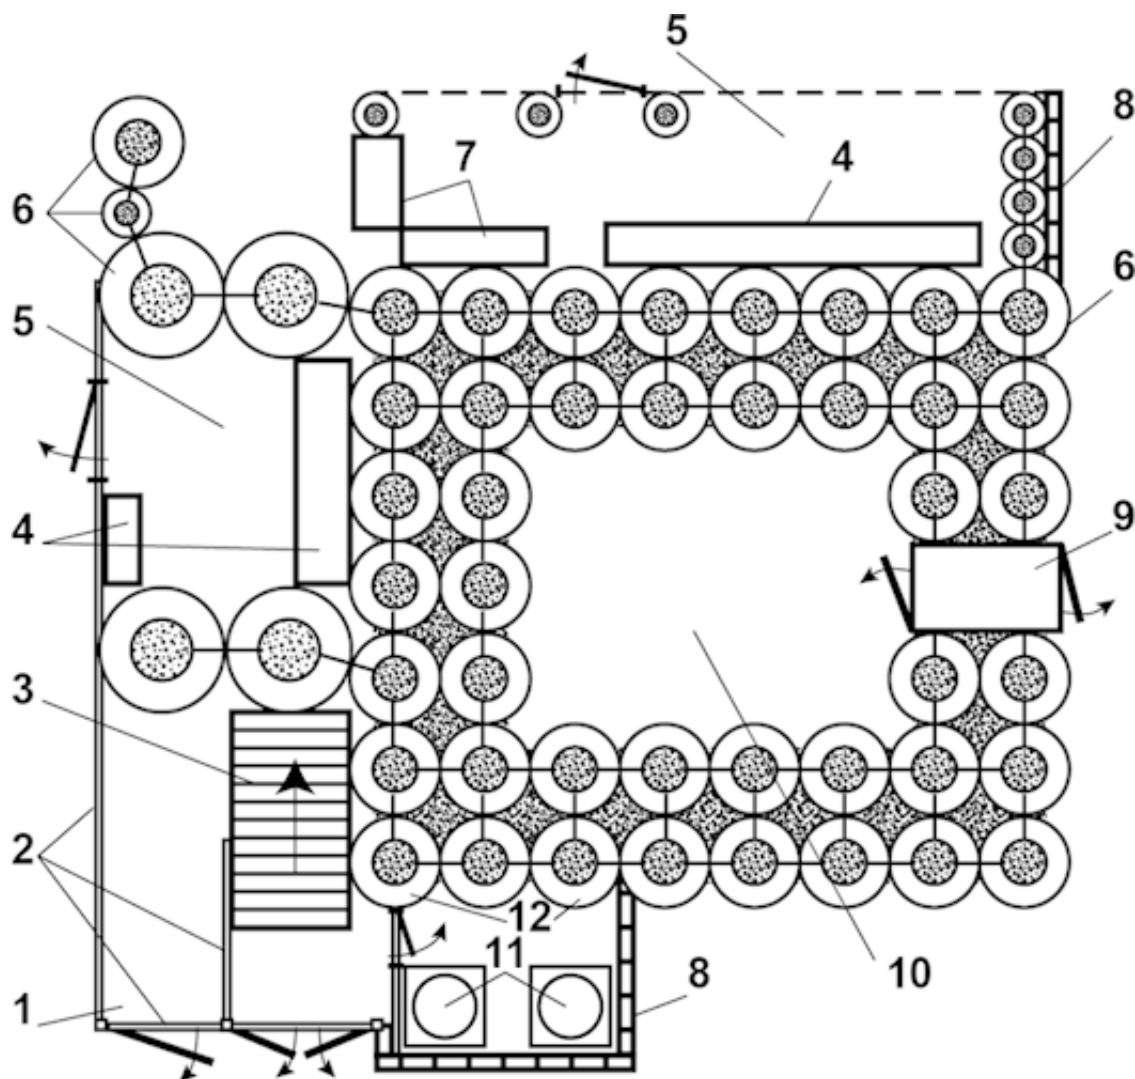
План основания дома: 1 – гараж для мотоцикла или велосипеда; 2 –каркас стены технического этажа; 3 – лестничный марш; 4 – верстак; 5 – мастерская; 6 – покрышки; 7 – стеллаж; 8 – кирпичная стена; 9 – входной шлюз; 10 – хранилище; 11 – люки канализации; 12 – колодцы с канализационными трубами
